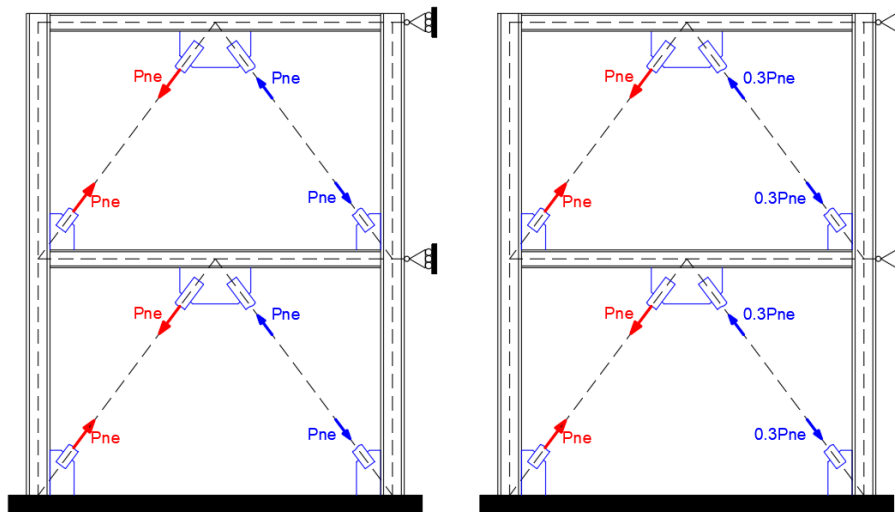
Modelo estructural para el diseño de vigas en un sistema SCBF
